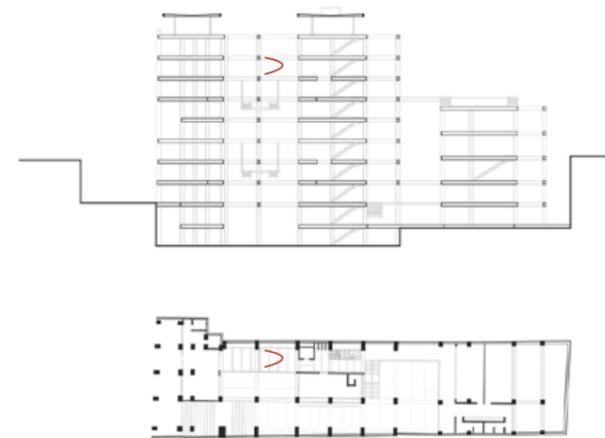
Ubicación del detalle constructivo 4. Fuente: Elaboración propia.
